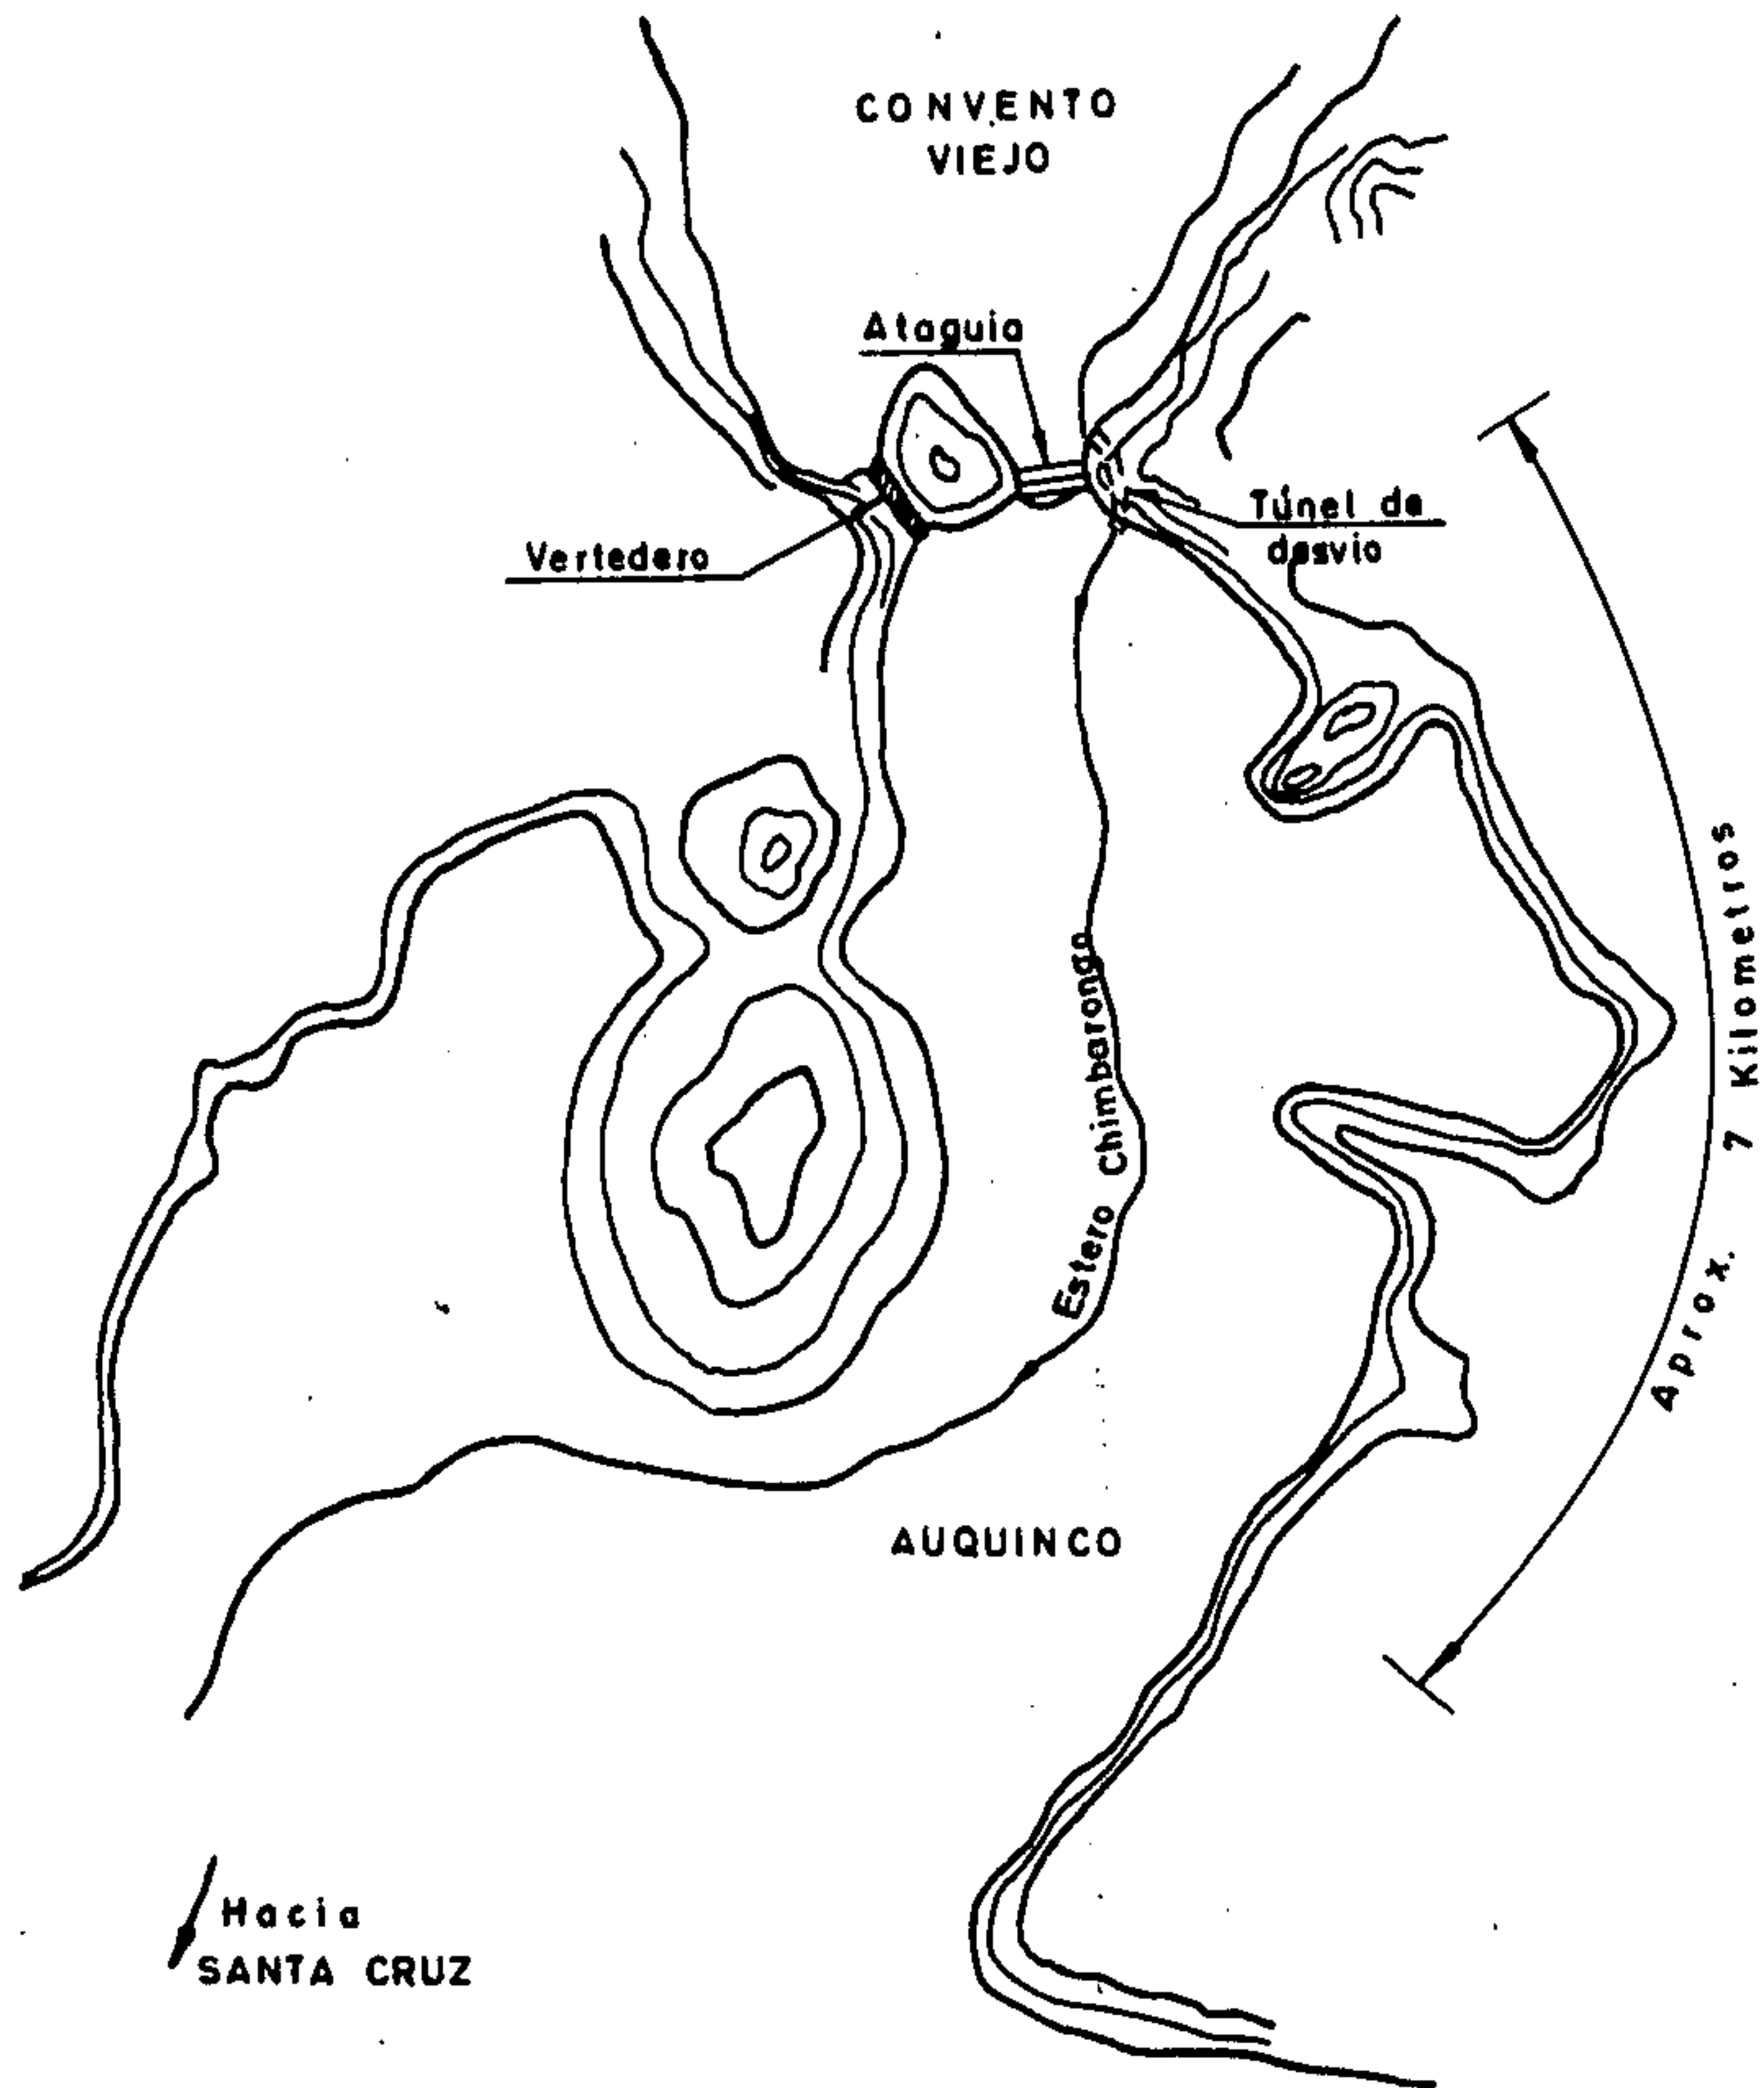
PLANO DE UBICACION GENERAL DE LAS OBRAS
